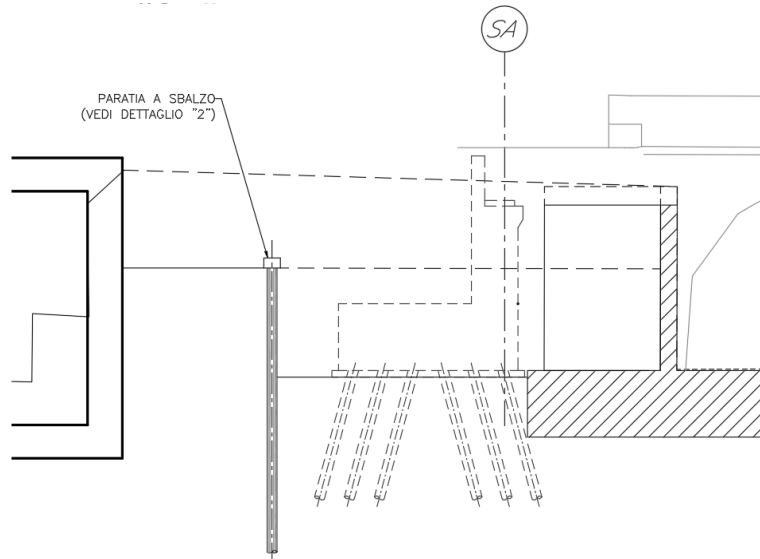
Sezione Opere Provvisionali Spalla A
